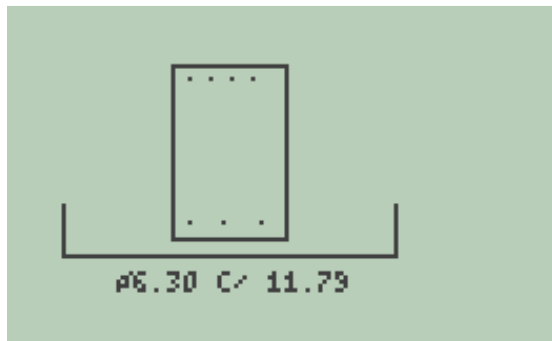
Sapatas Associadas - Detalhamento da viga, armadura transversal da laje.
